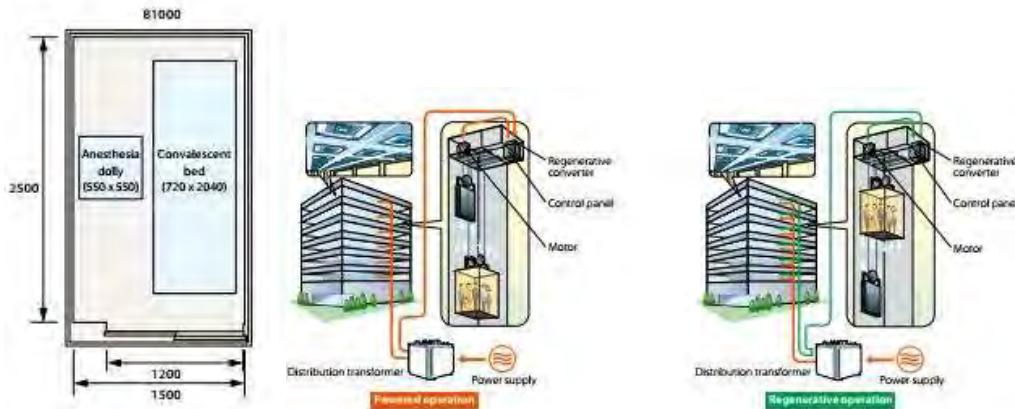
ukuran kamar lift, potongan, dan denah kamar lift
